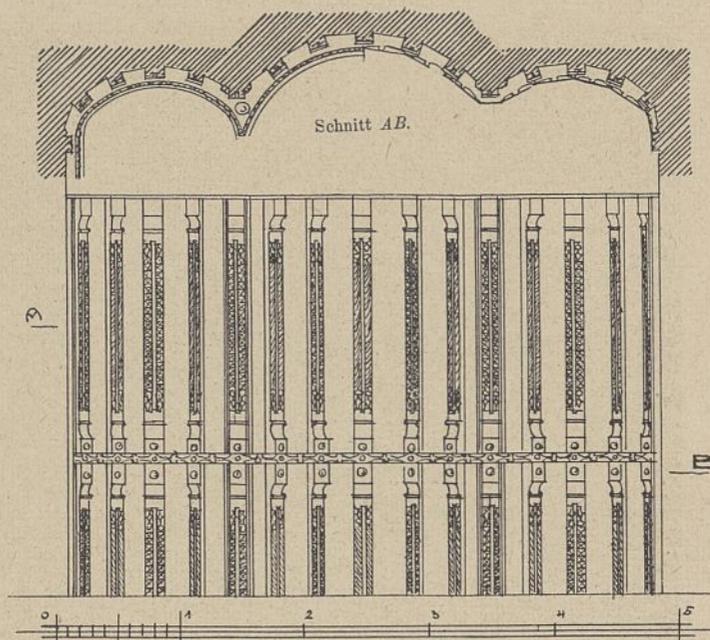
Schnitt, Grundriß der Decke zu Abb. 35.
